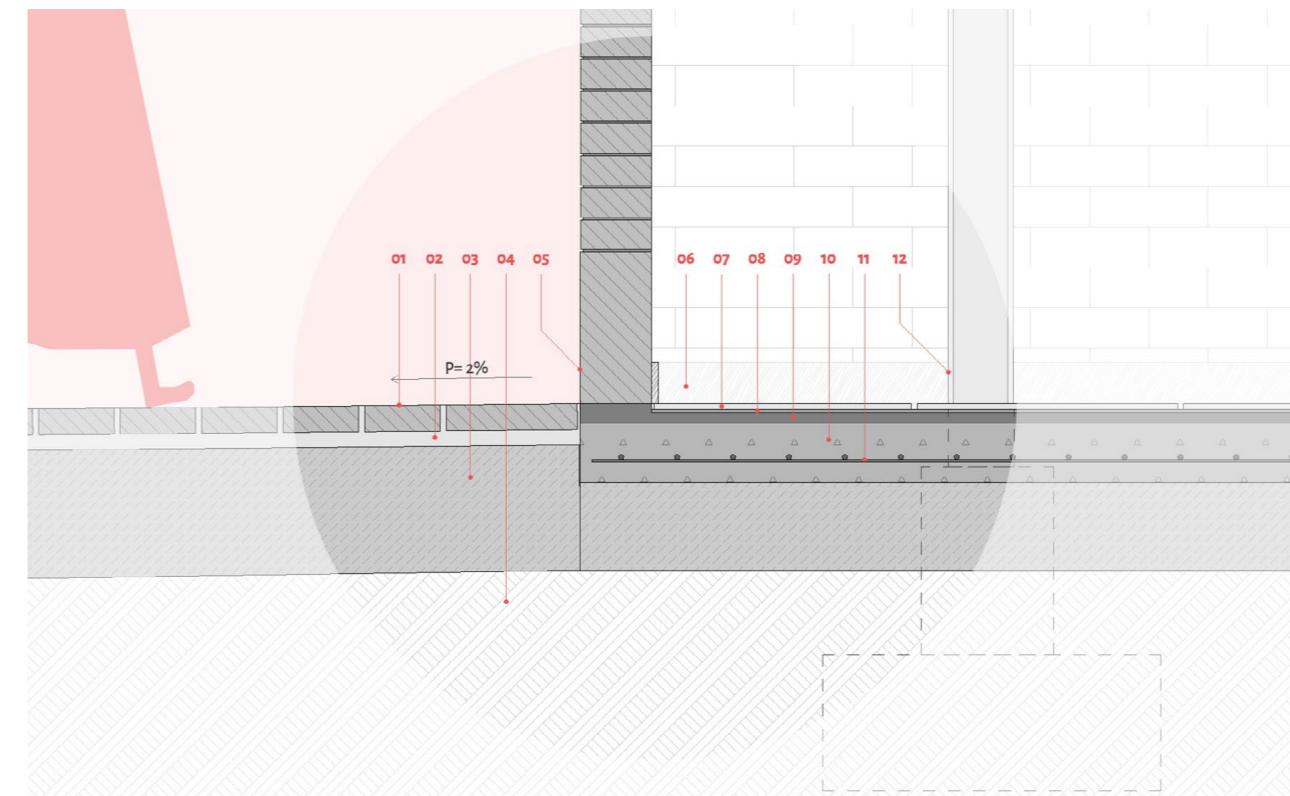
Detalle Constructivo 02 Fuente: Elaboración Propia
